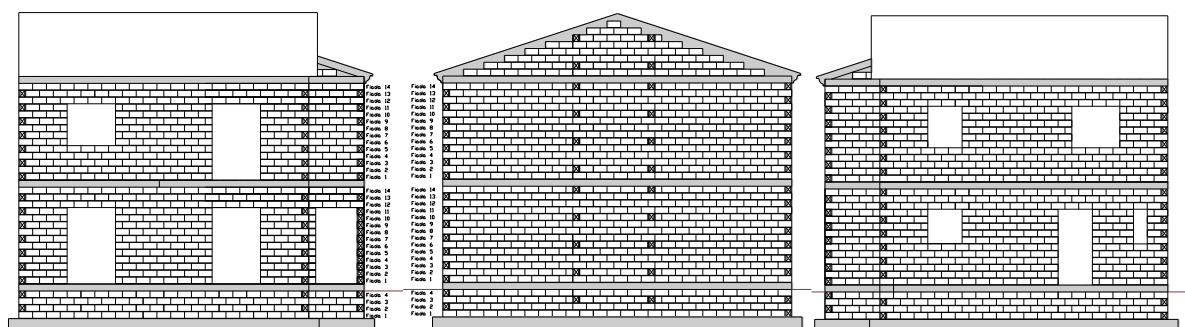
Modulação estrutural das fachadas da moradia na Mealhada
